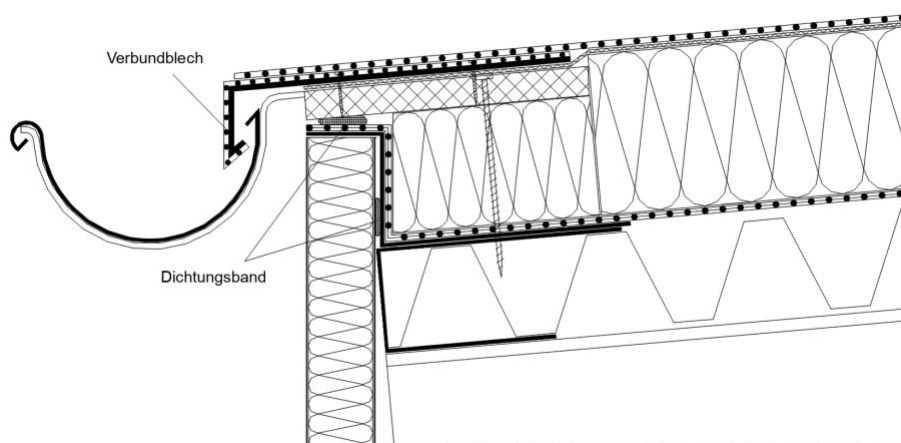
Dachrandabschluss mit vorgehängter Rinne – Ausführung mit Kunststoff-/Elastomerbahnen
